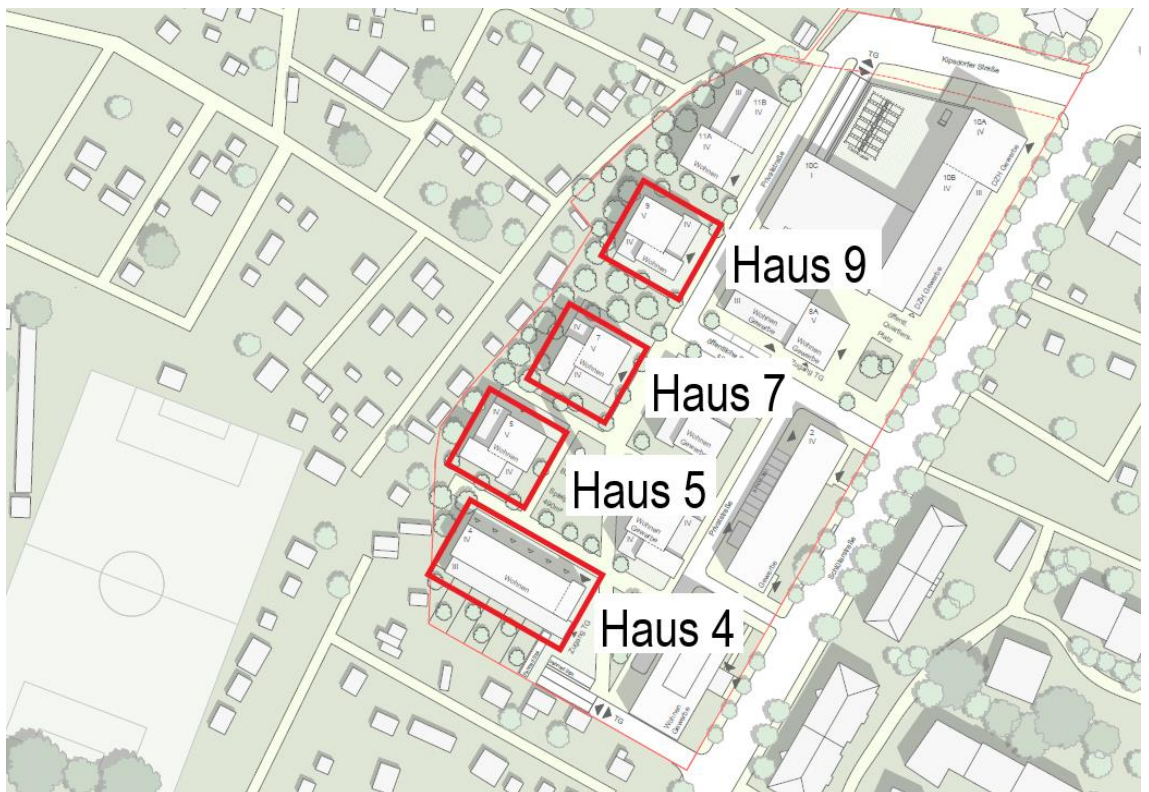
Vorentwurf des Vorhaben- und Erschließungsplans vom September 2022 mit Lage der geplanten Wohn- und Gewerbegebäude [1].
